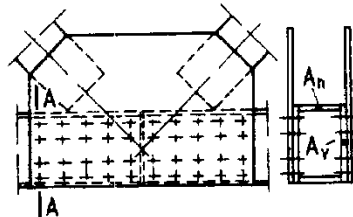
Расположение проверяемого на выносливость расчетного сечения А-А по основному металлу в сечениях нетто у отверстия с поставленным в него высокопрочным болтом, затянутым на нормативное усилие
